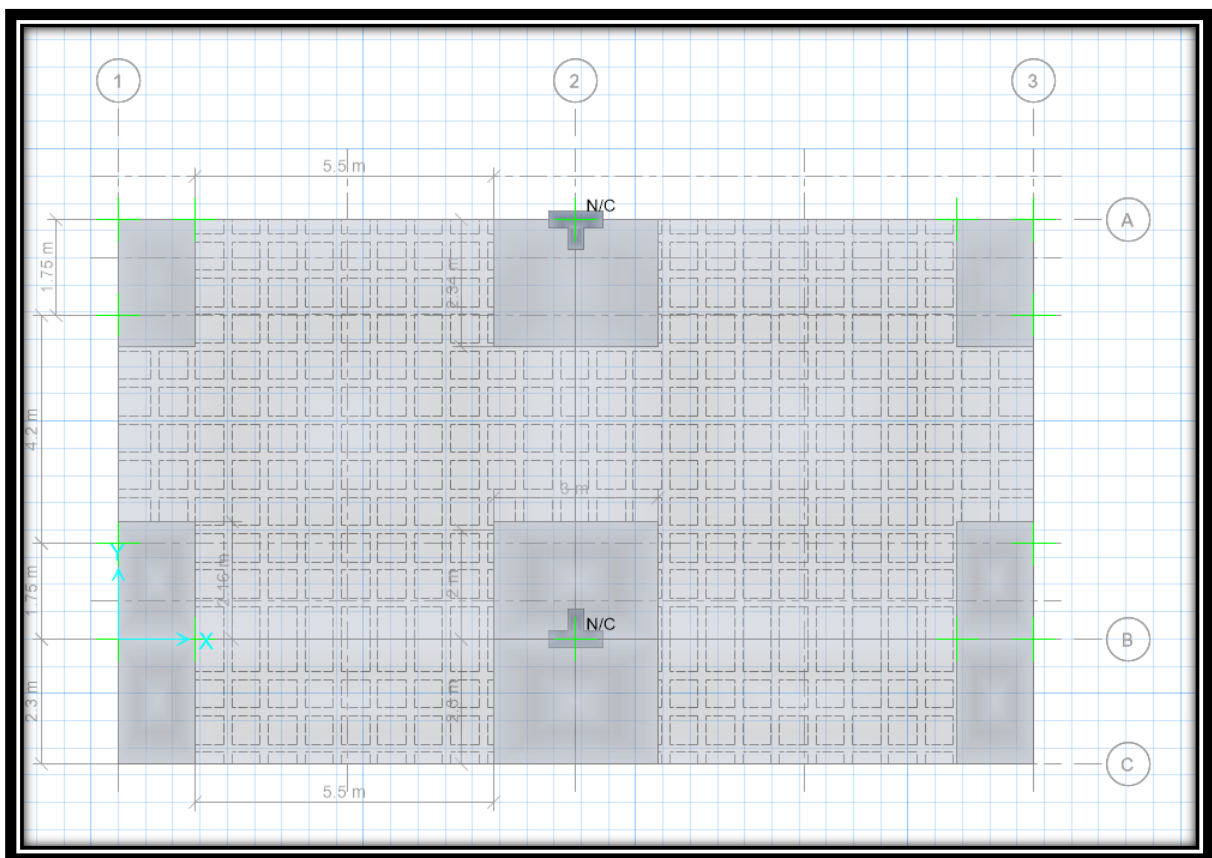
Perímetro crítico de esfuerzo cortante con cargas 1.4D+1.7L correspondientes Primer Piso.
